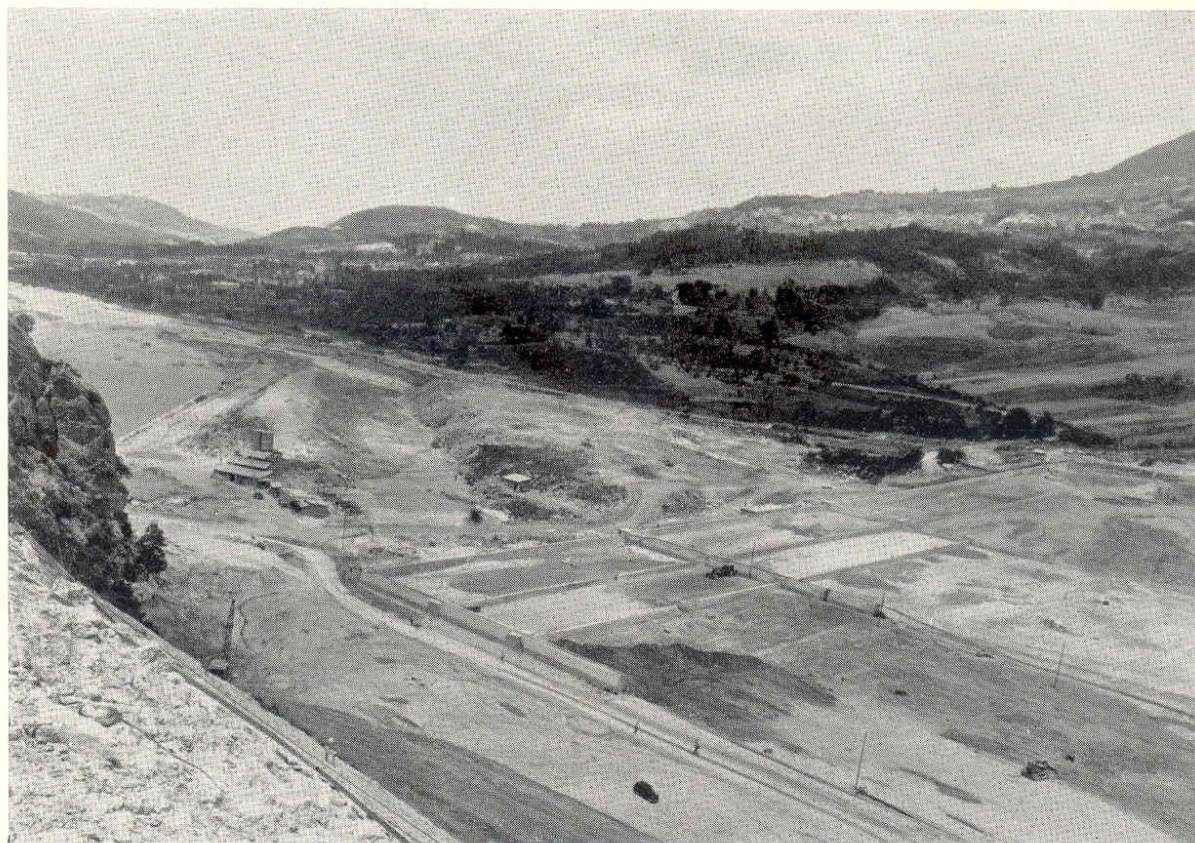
DIGA DI BOMBA — Vista dei cunicoli di drenaggio sotto la zona filtrante e del piano di impostazione della diga.
